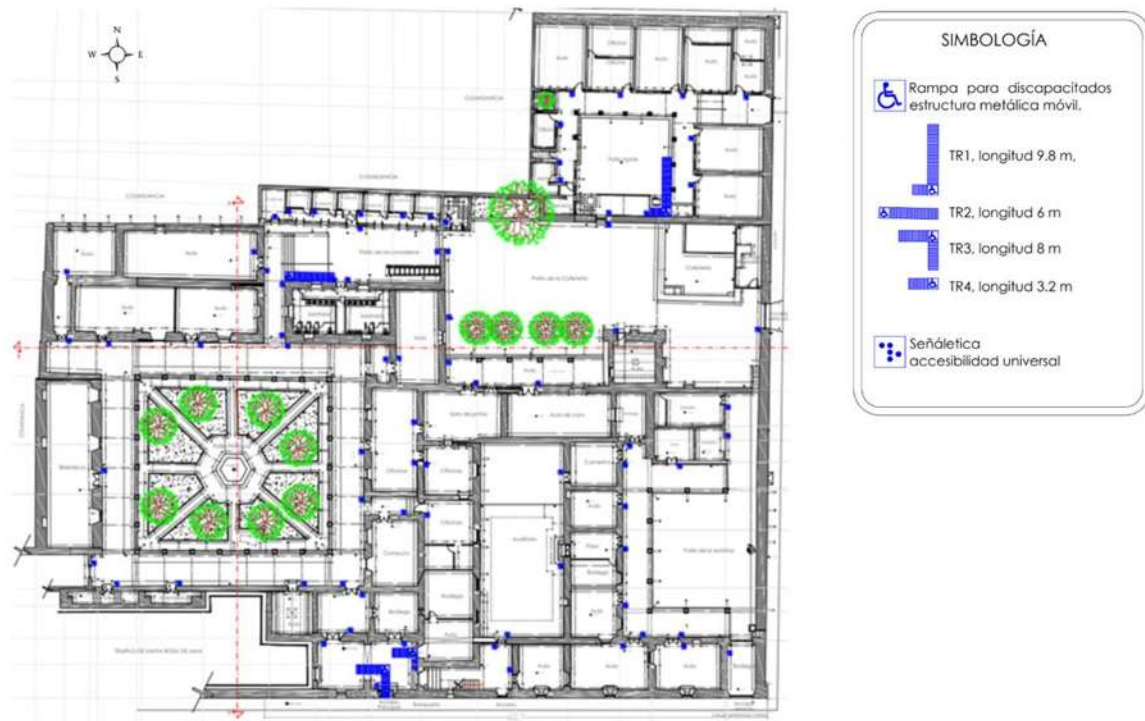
Proyecto de Adecuación, sección del plano, elaboración propia.
